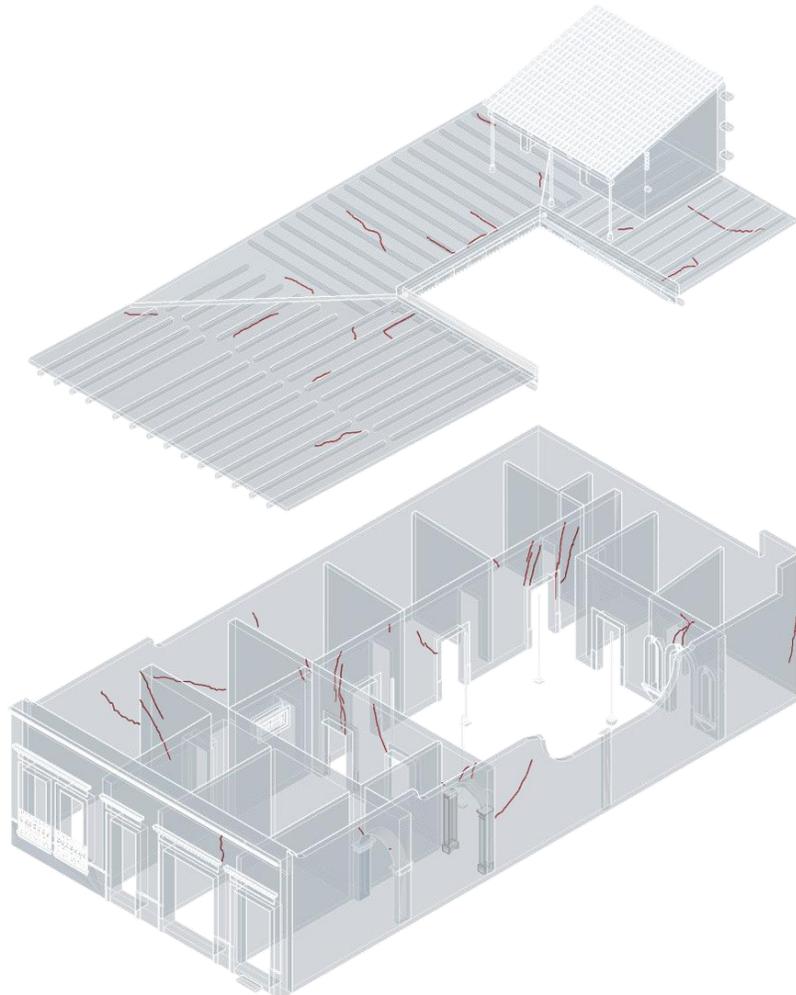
Grietas y fisuras en el caso de estudio. Elaborado por KNV.
